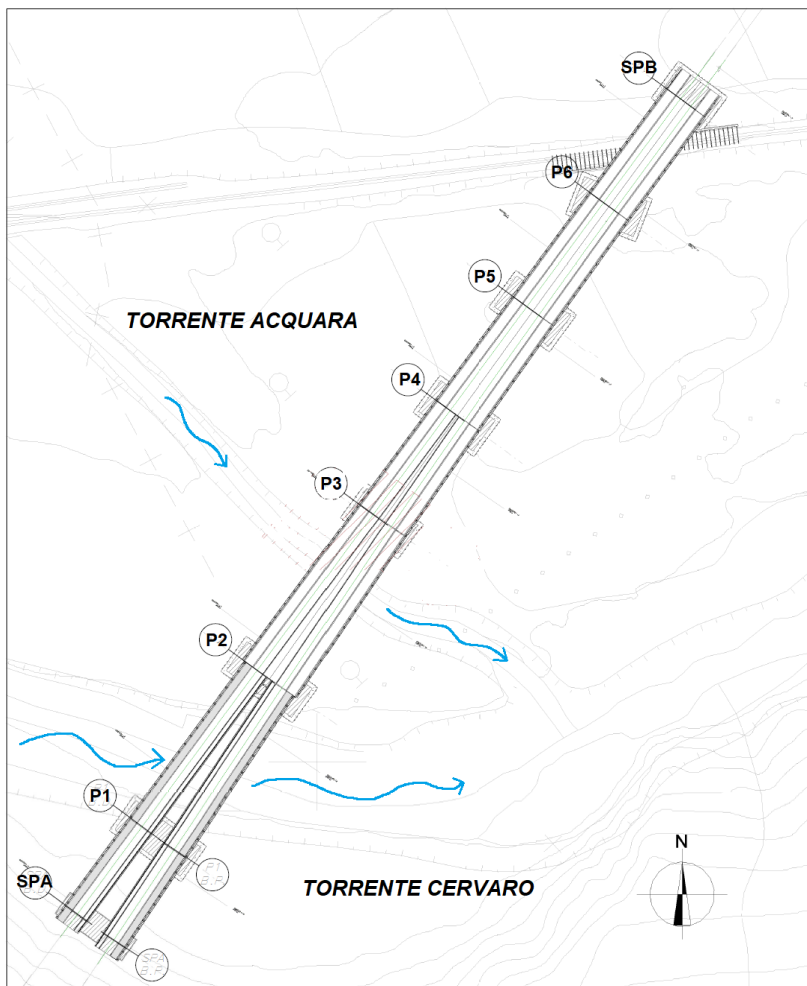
Stralcio planimetrico del viadotto in progetto sul Torrente Cervaro.
